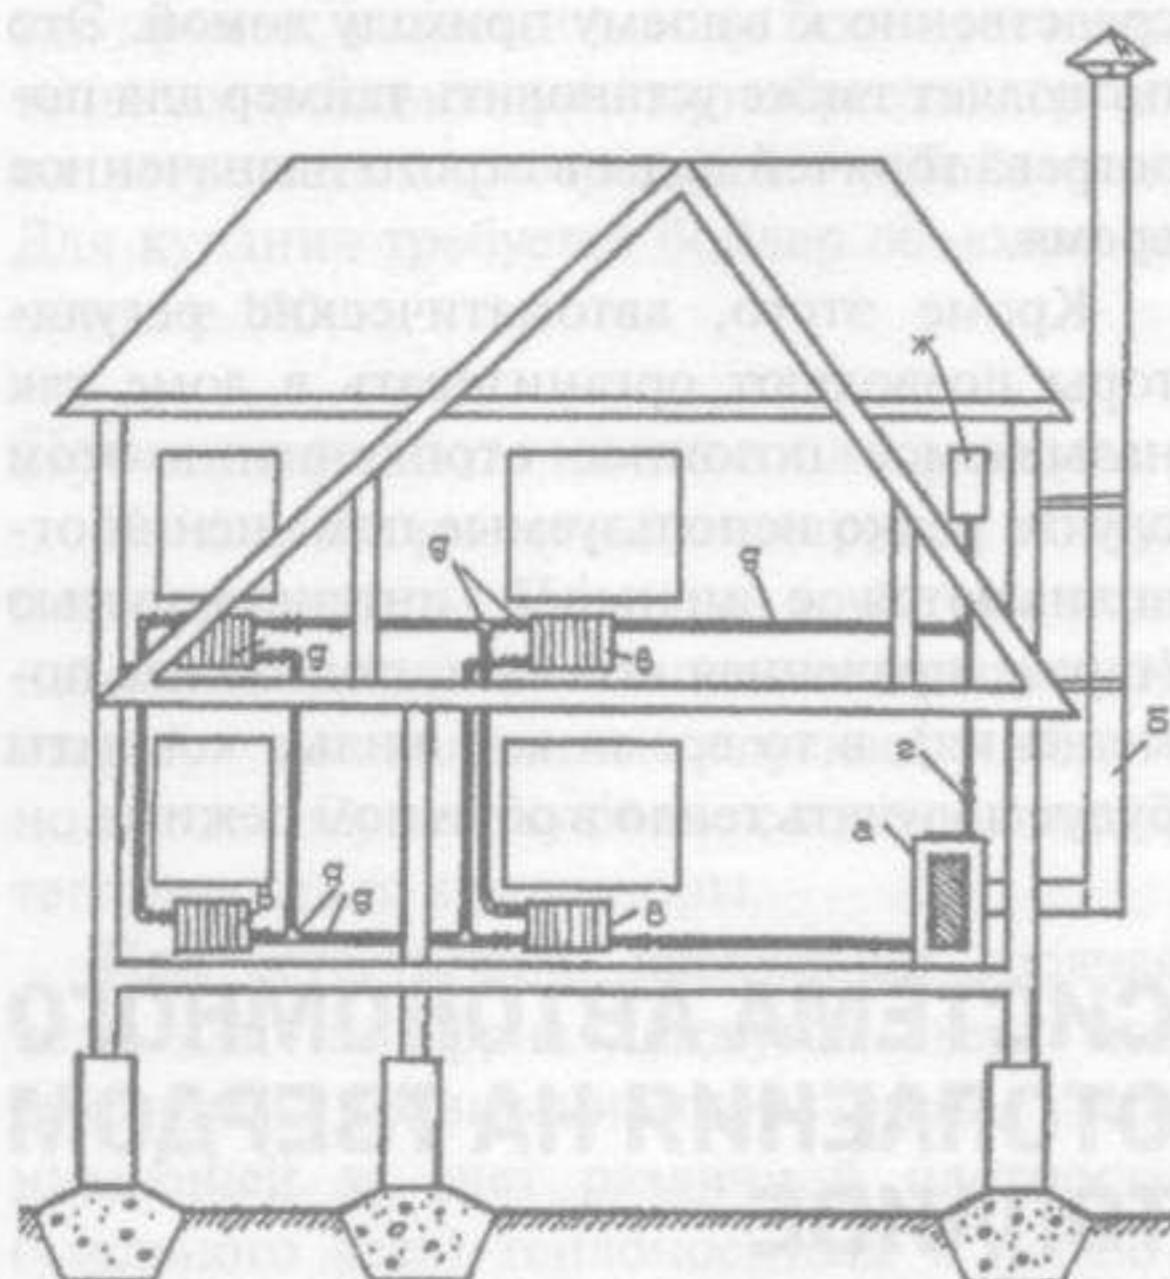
Схема системы автономного отопления на твердом топливе: а – котел КЧМ-5; б – дымоход эмалированный неутепленный; в – чугунные семисекционные радиаторные батареи; г – циркулярный насос «grundfos»; д – соединительные трубы и фитинги стальные неоцинкованные; ж – сварной металлический расширительный бачок.
